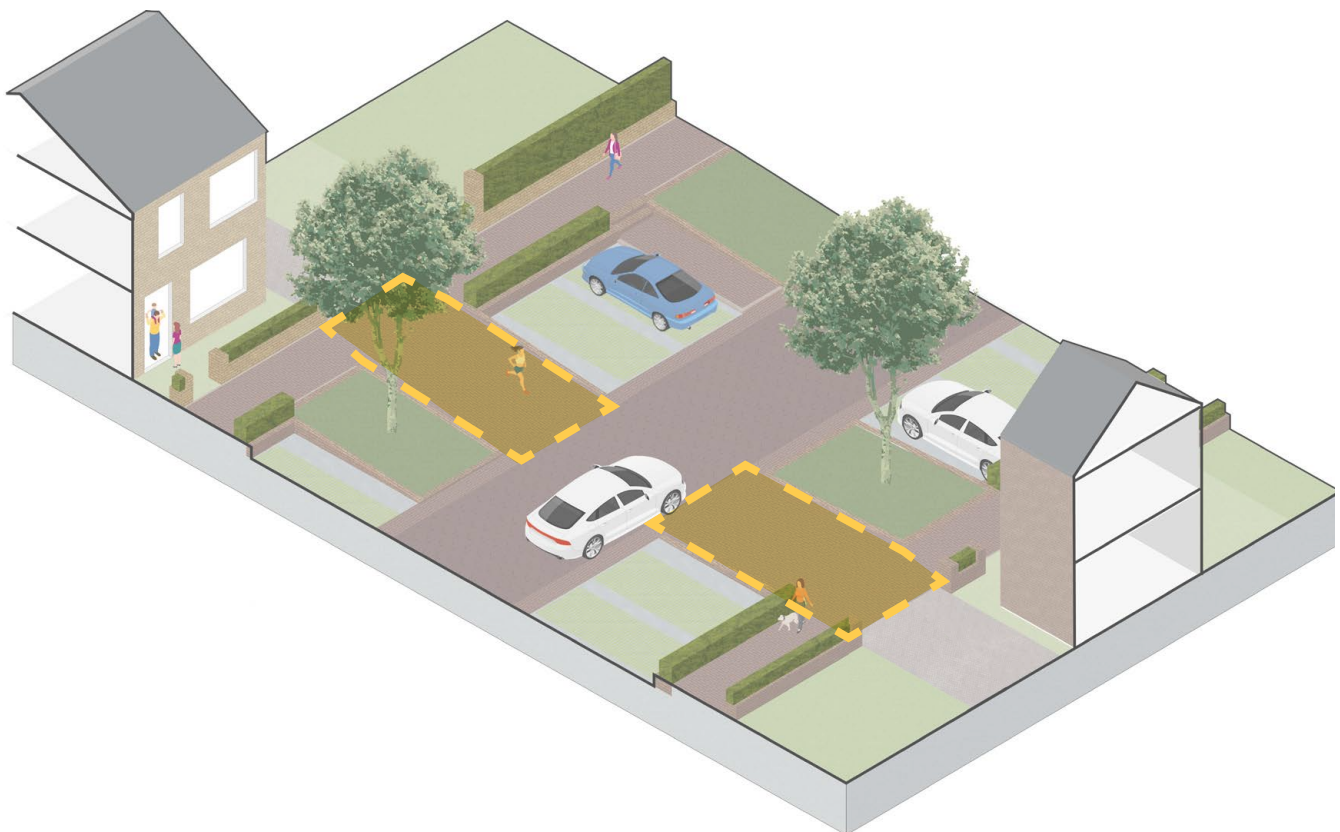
erfafscheiding zonder achterpad, profiel B' waar vanuit de woning het landschap waargenomen kan worden
